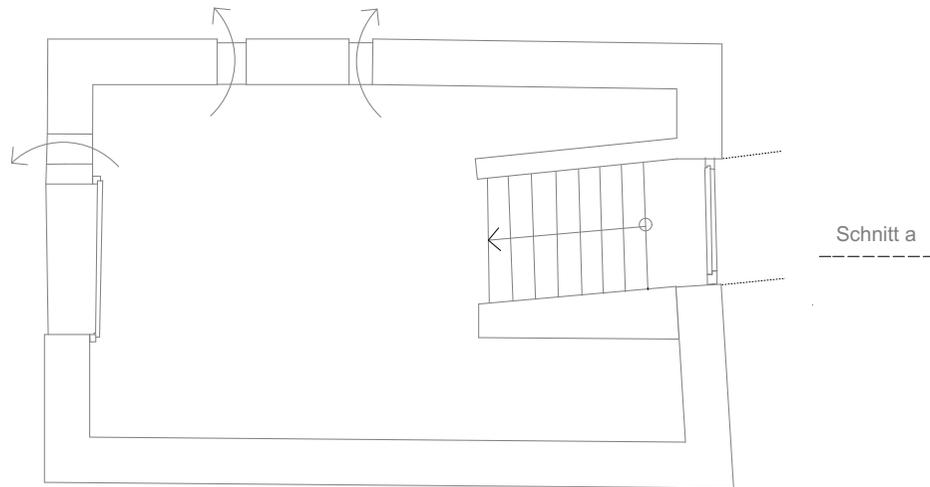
Grundriss Gemeinschaftskeller EG 1:100
